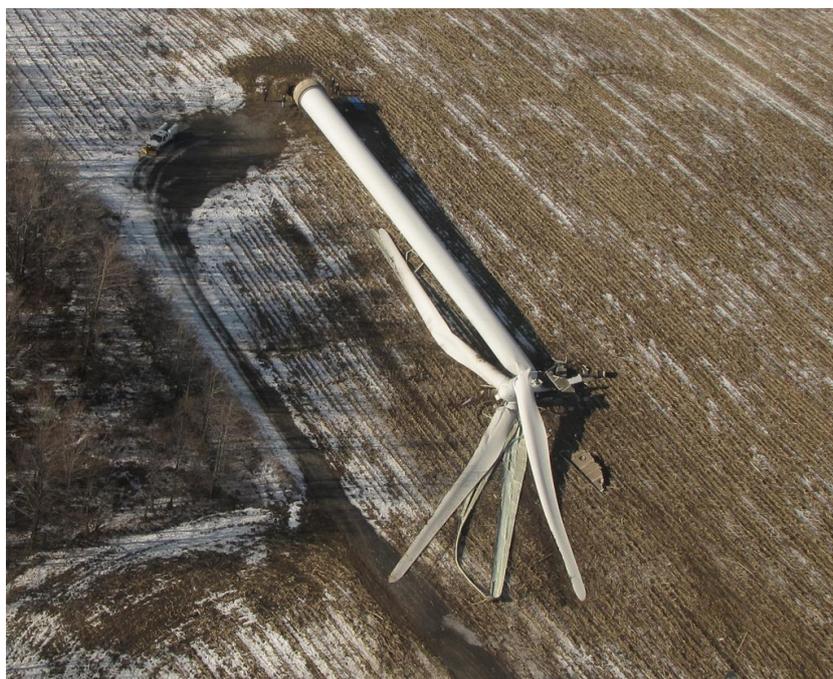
Rovesciamento completo dell'insieme turbina-fondazione
